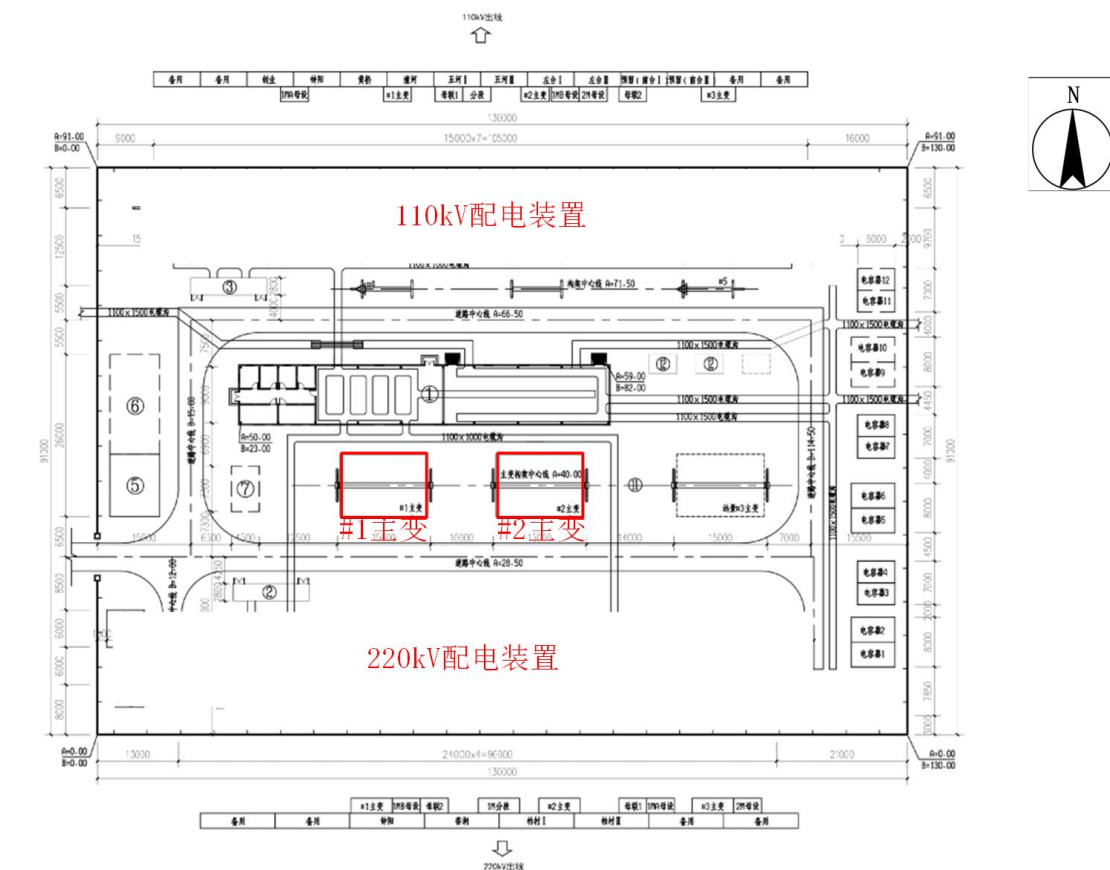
类比头铺 220kV 变电站平面布置示意图
